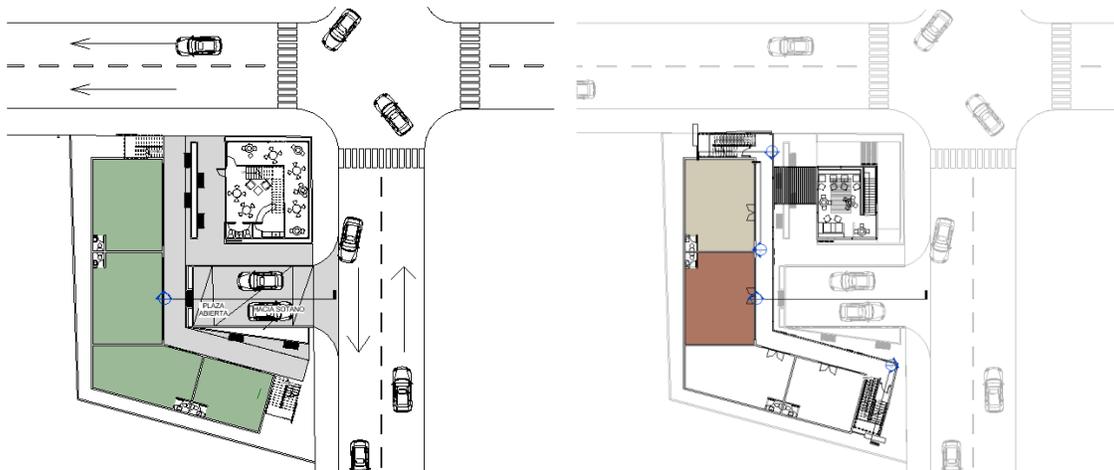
Planta Arquitectónica 1er y 2do Nivel: Plaza Comercial
